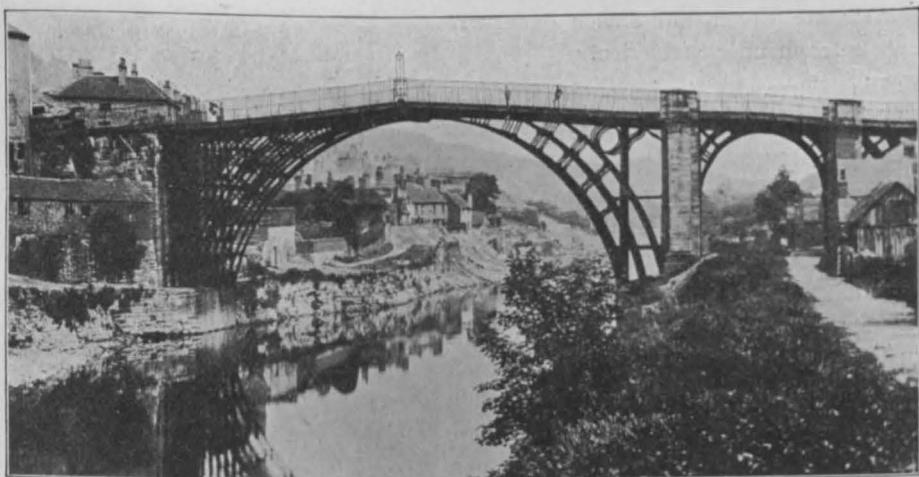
Jetzige Gestalt der Severnbrücke bei Ironbridge (Brücke von Coalbrookdale).
